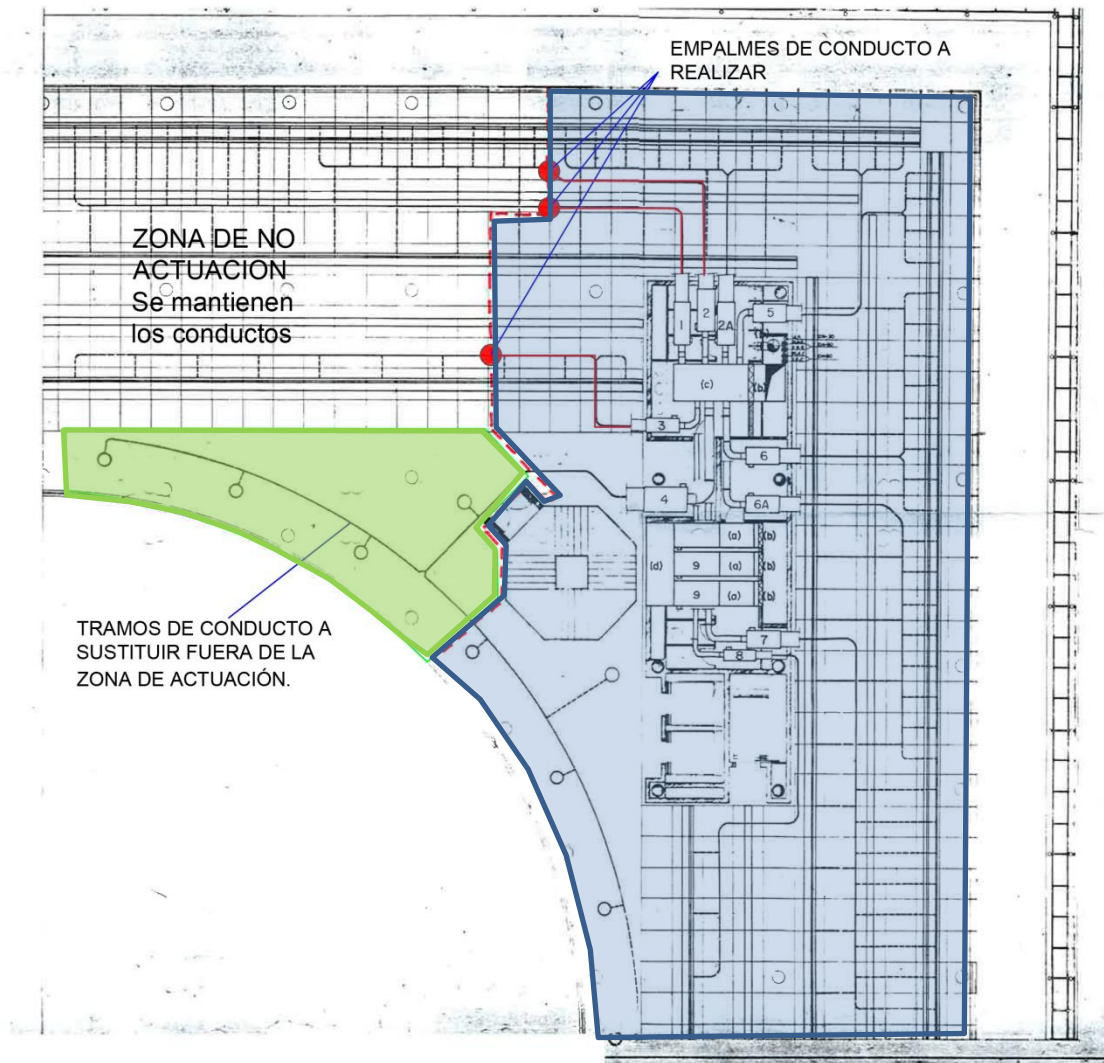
Plano de climatización de la zona noreste. Zona de actuación (azul)
